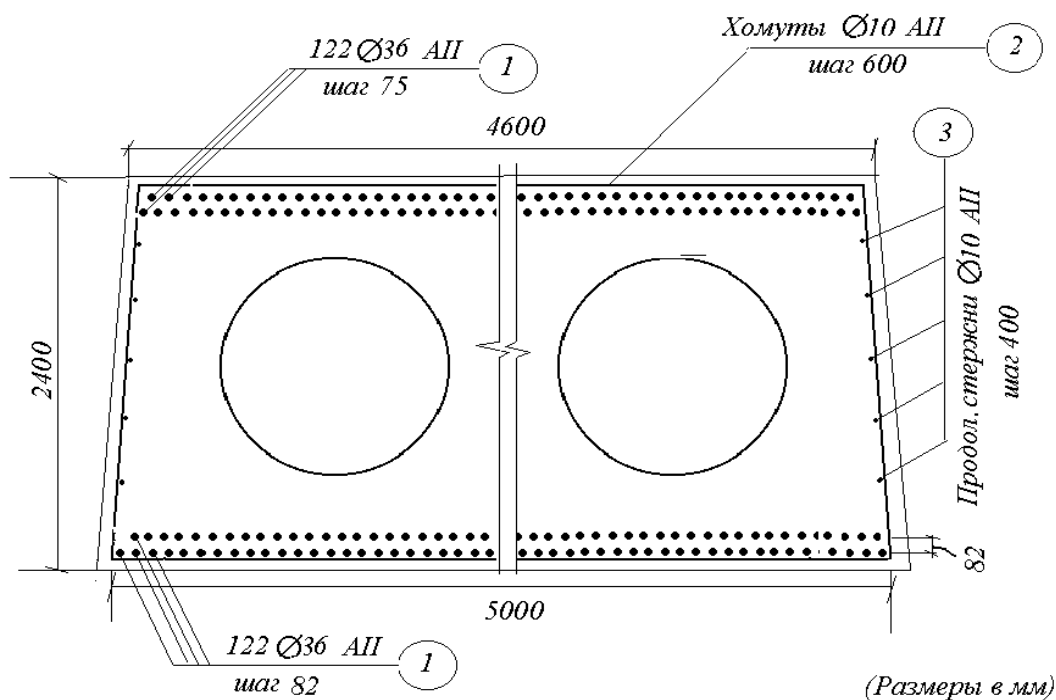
Схема размещения арматуры при бетоне В15 и арматуре АП
